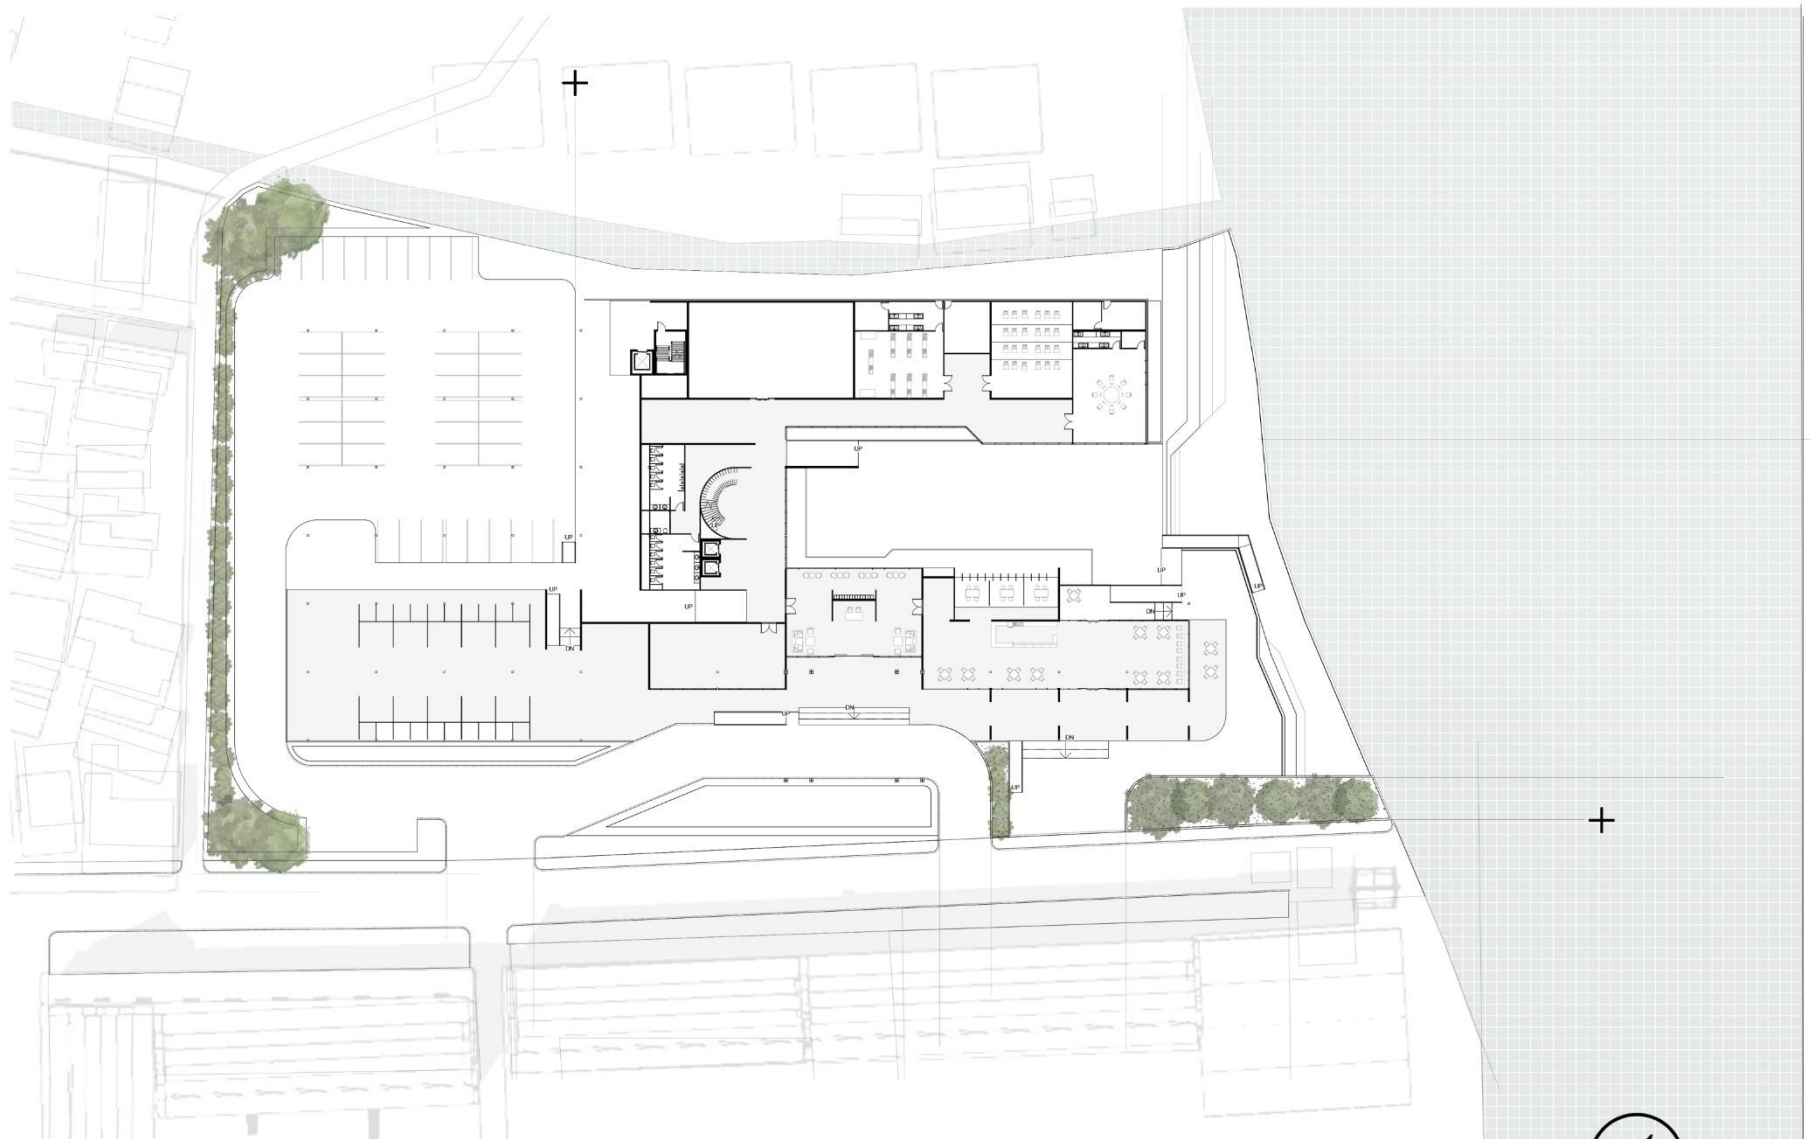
Schematic design 3 ground floor plan - ธวัชชัย 2021
